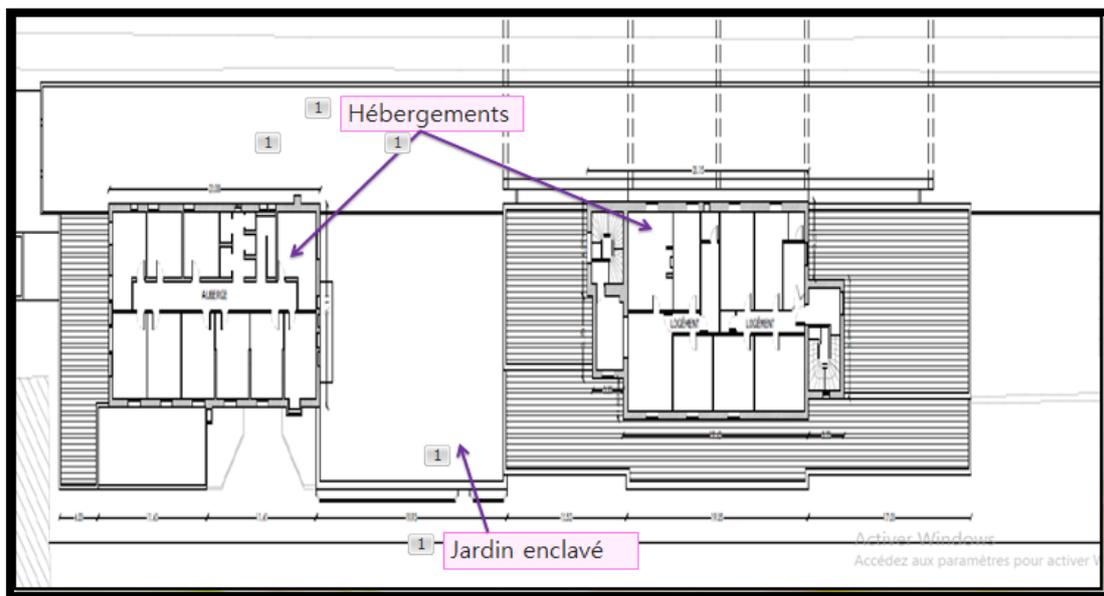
Plan d'étage de la gare ferroviaire de Tlemcen
